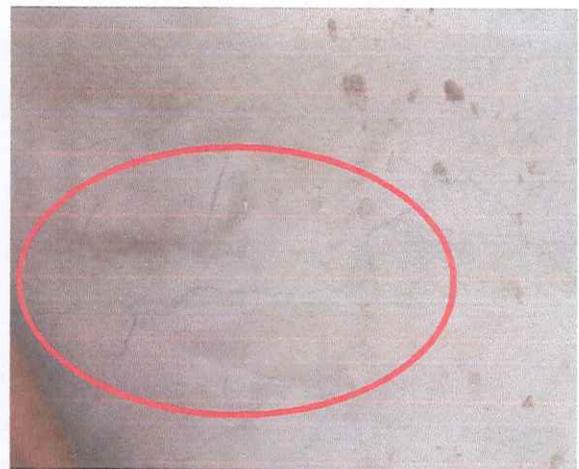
Presencia de fisuras en muro interior de casetas UBS
